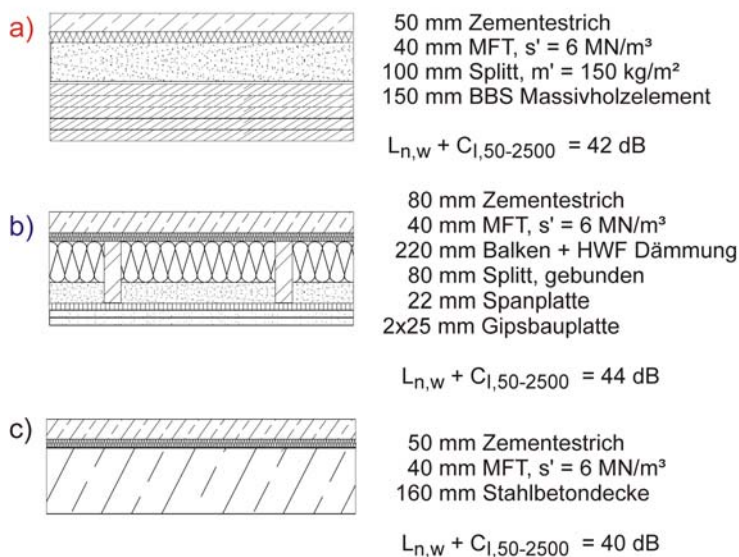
Messwerte optimierter Holzdecken im Vergleich zu Stahlbetondecken
